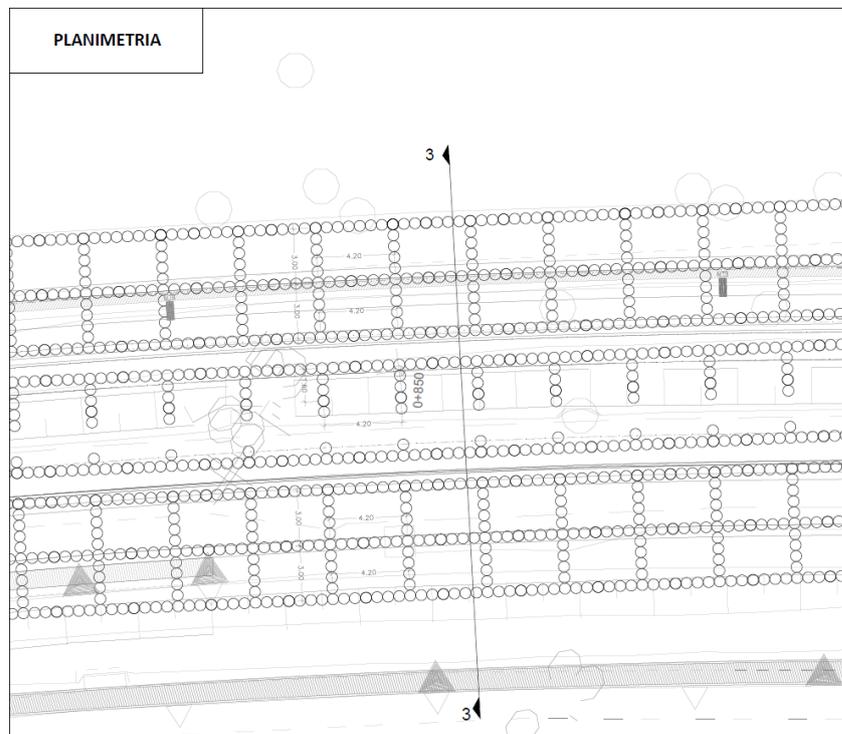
Sezione rappresentativa Fermata San Marco tratta 0+793 – 0+900 - planimetria
